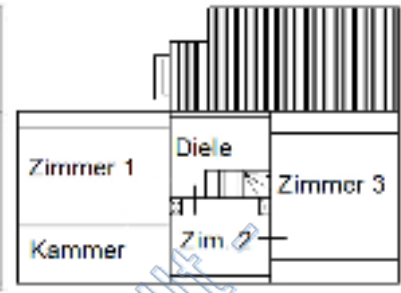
Grundrisssskizze Obergeschoss
